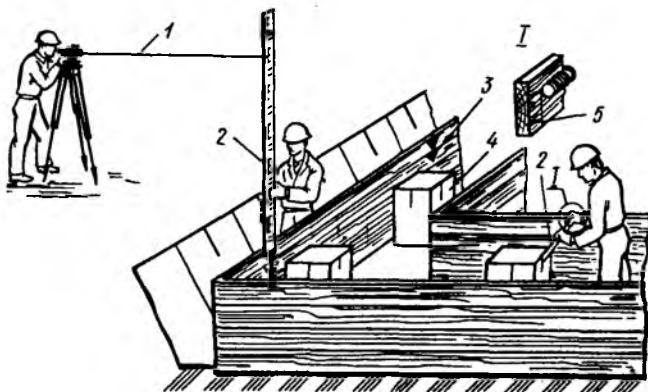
Разбивка осей и отметок для установки арматуры и выверки опалубки (арматура условно не показана):
